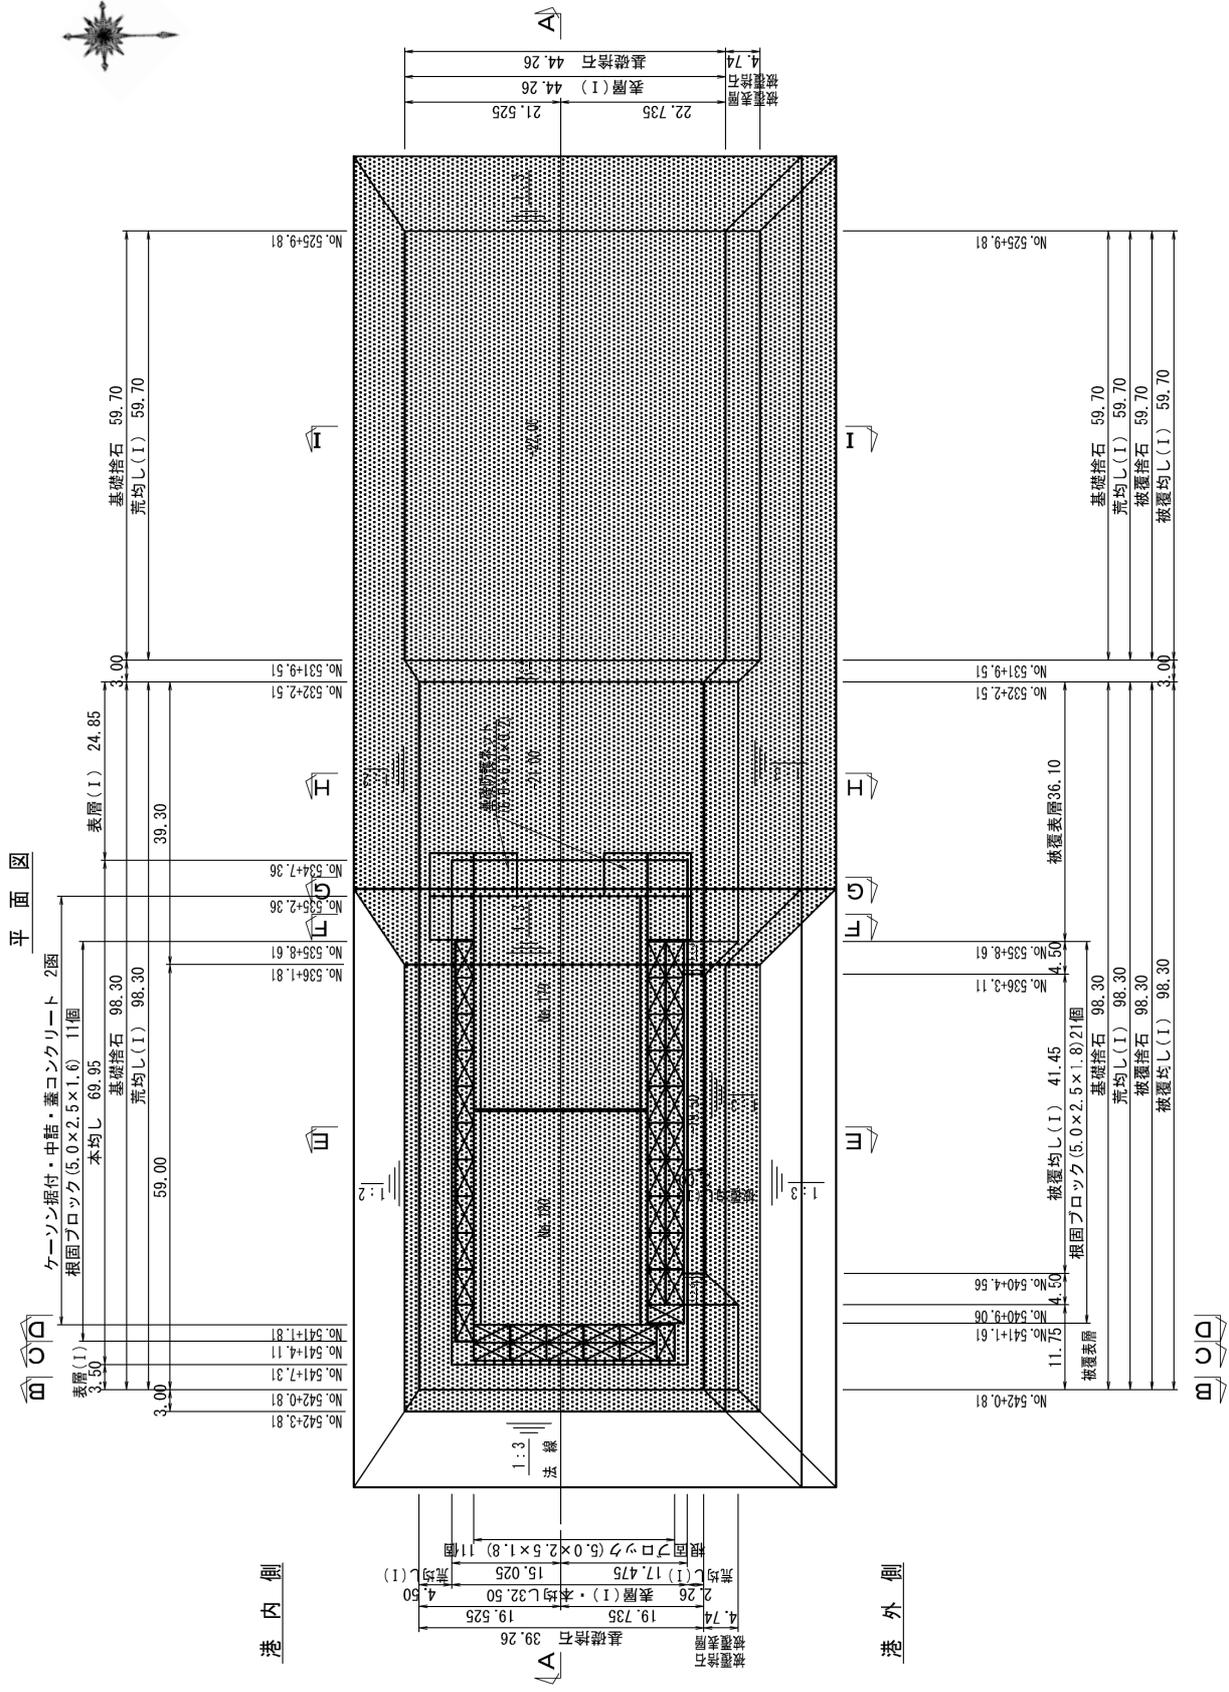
No.2 常陸那珂港区_東防波堤平面図 (被災前)
